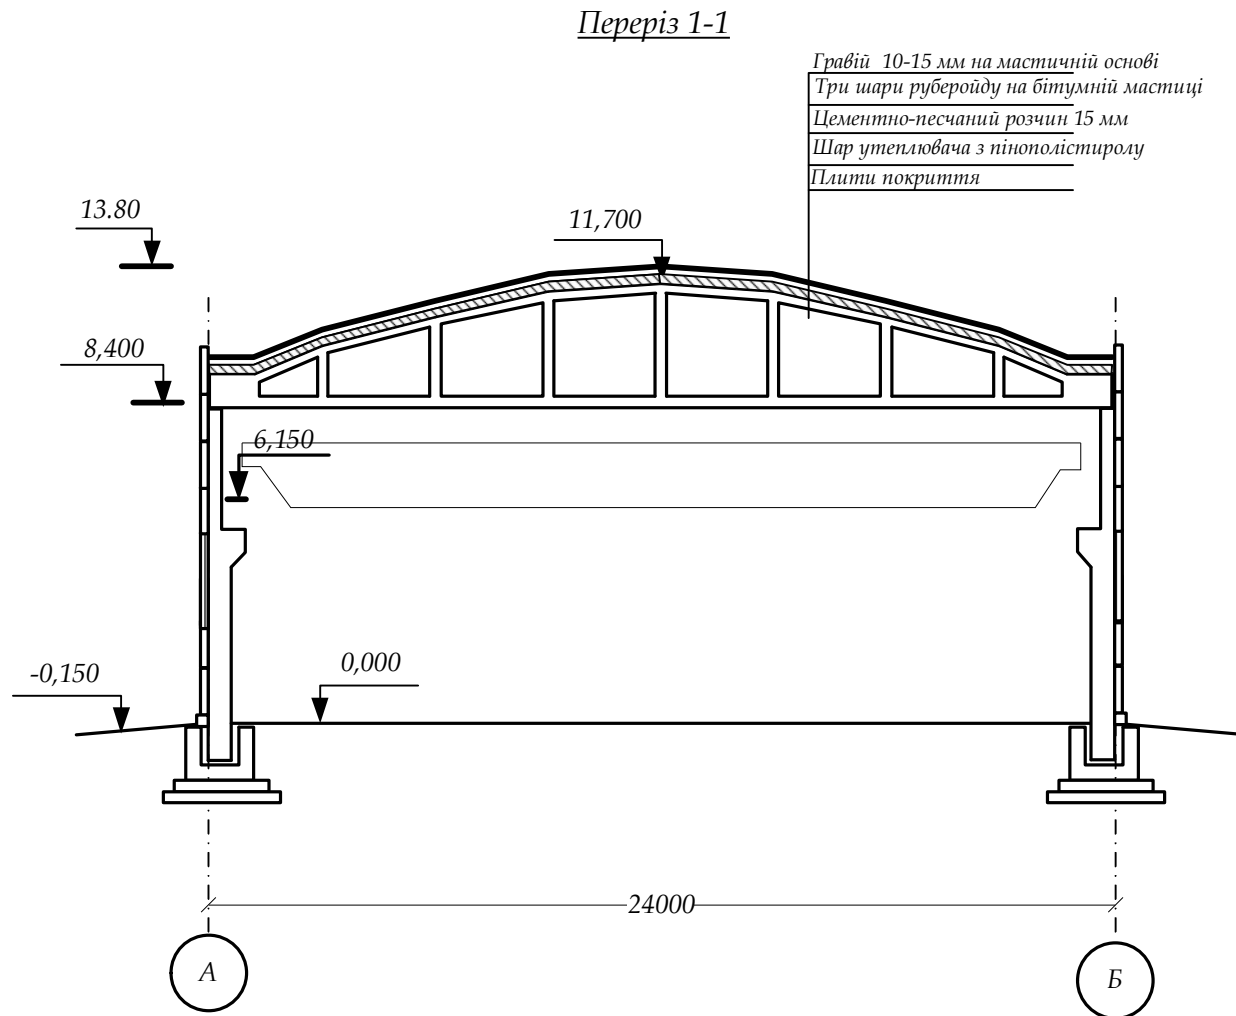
Поперечний переріз промислової одноповерхової будівлі
